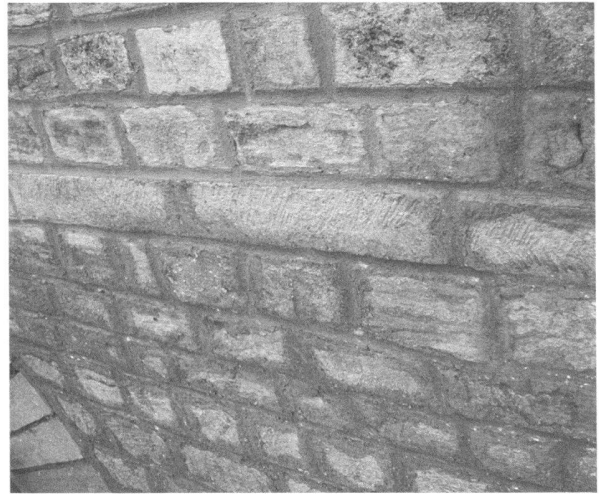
Mur d'enceinte. Détail du parement côté campagne après restauration (photo MRA).
